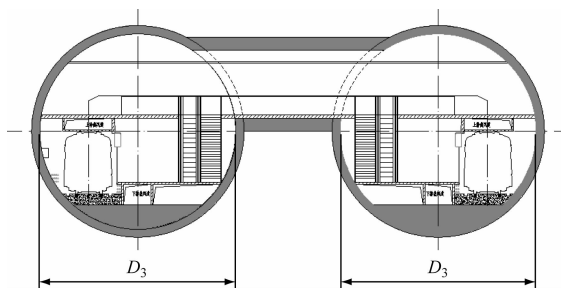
采用大直径盾构施工的分离岛式隧道横断面布置图
